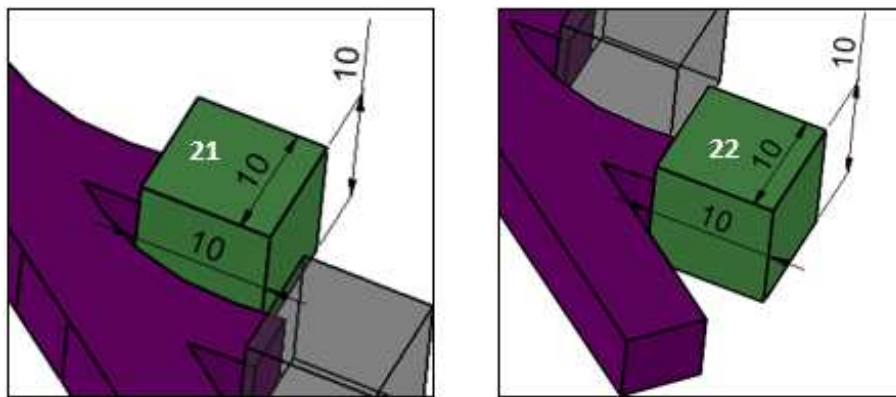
Baustofflager und Baustoffanlage mit Dimensionen
